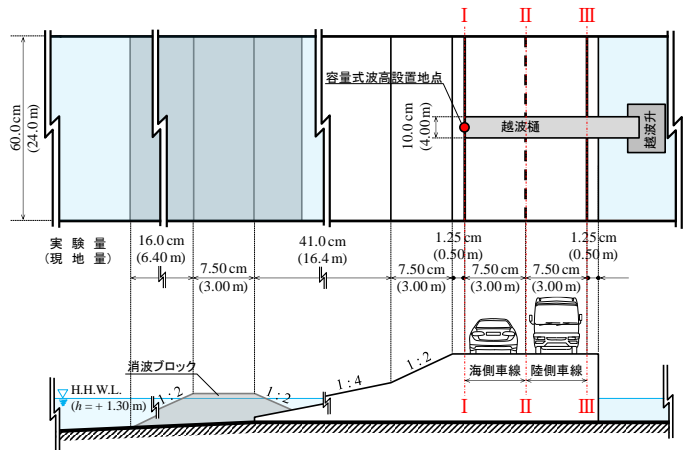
実験に用いた緩傾斜護岸の断面図および平面図
